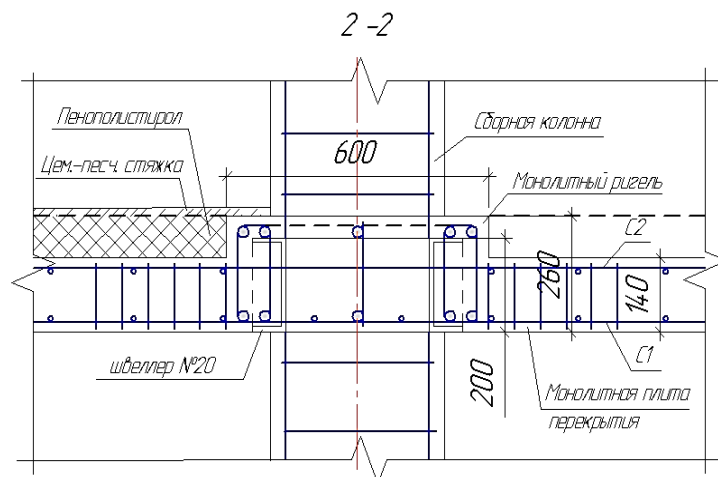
Узел стыка монолитного балочного перекрытия с колонной. Сечение 1-1
